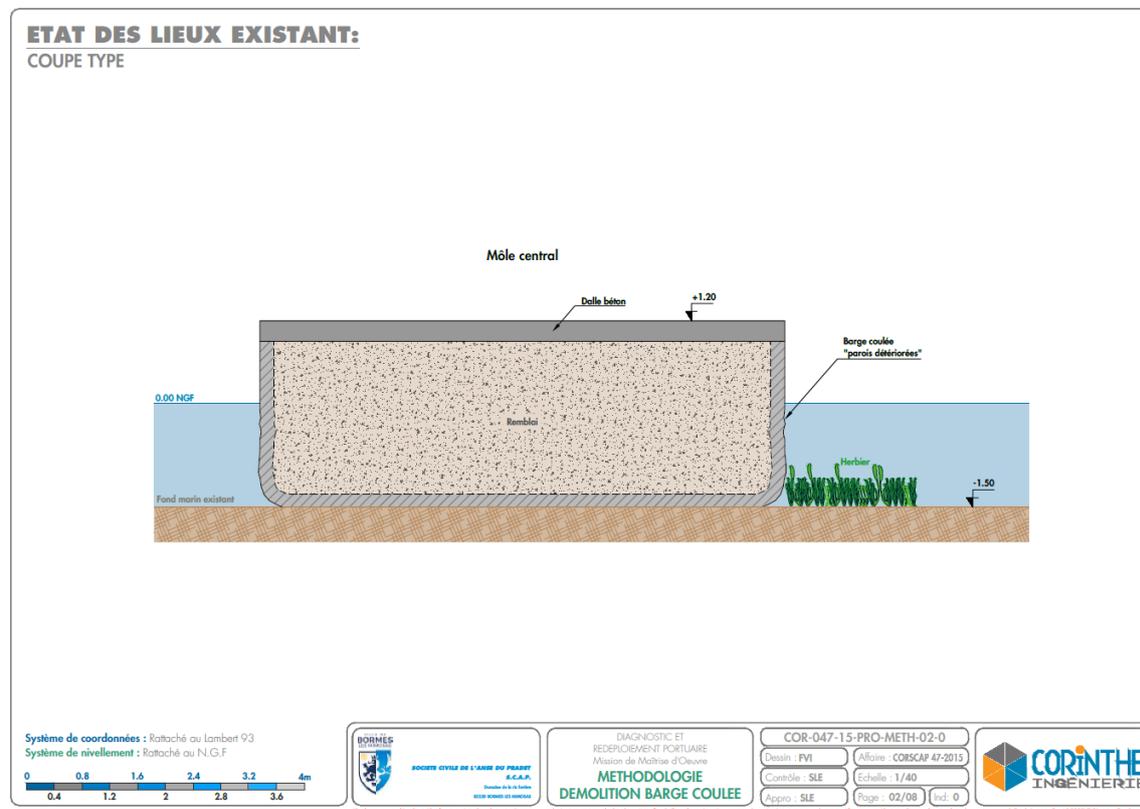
État des lieux existant - Coupe (Figure 135 Dossier LEMA)
